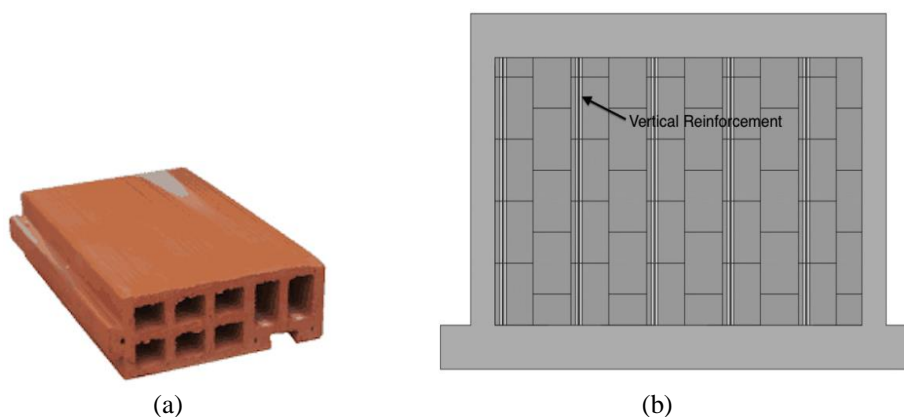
Detalhes do sistema construtivo de paredes de enchimento com blocos de furação vertical e encaixe; (a) tijolo; (b) parede de enchimento
